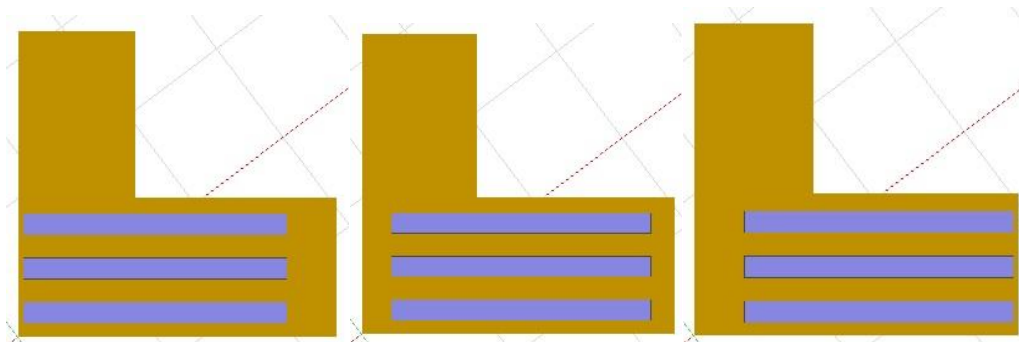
Configuração dos módulos na orientação 'paisagem' instalados em diferentes posições sobre a laje.
